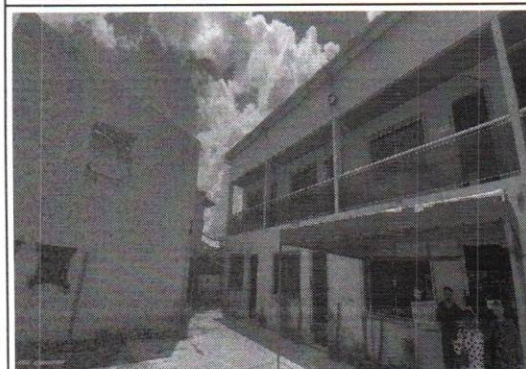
Vista do imóvel com 02 pavimentos para as salas de aula.
